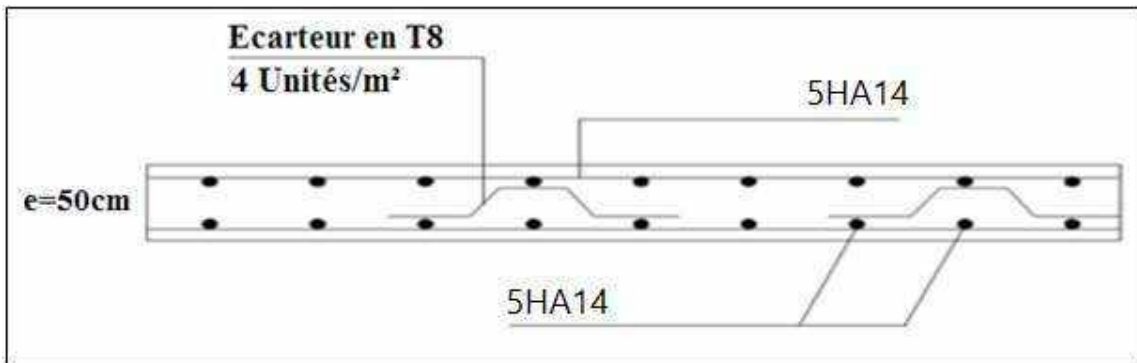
Ferrailage de la dalle dans les deux sens.
